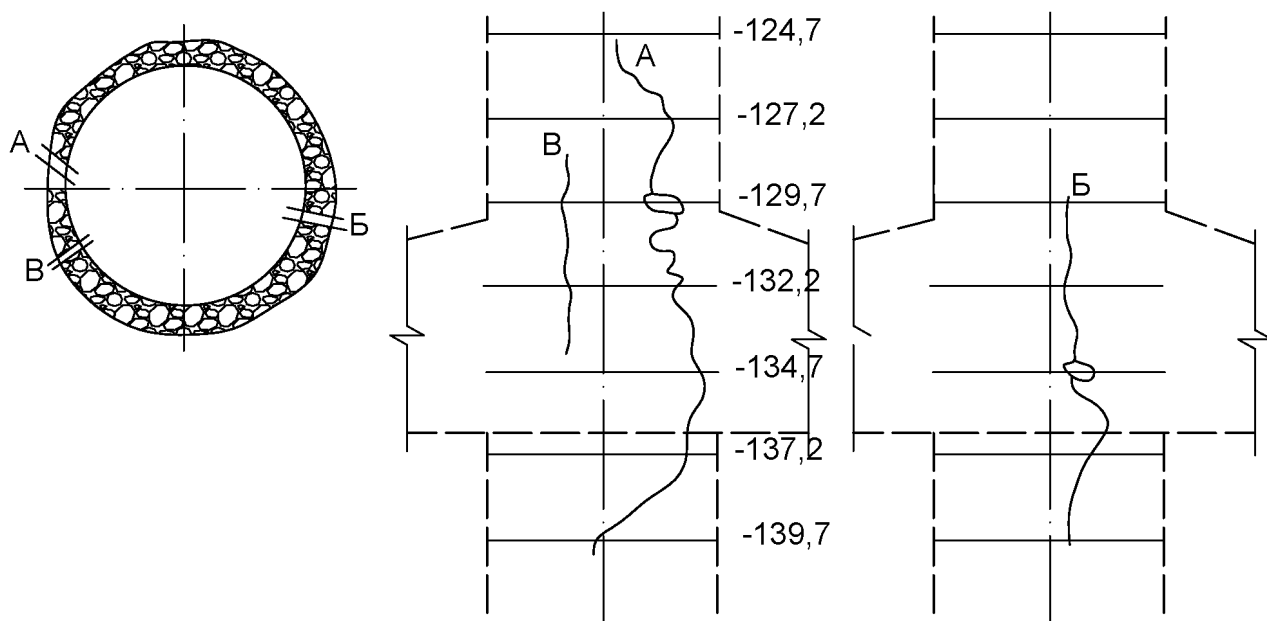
Схема расположения трещин в бетонной крепи ствола шахты «Новая Капитальная» Таштагольского рудника
